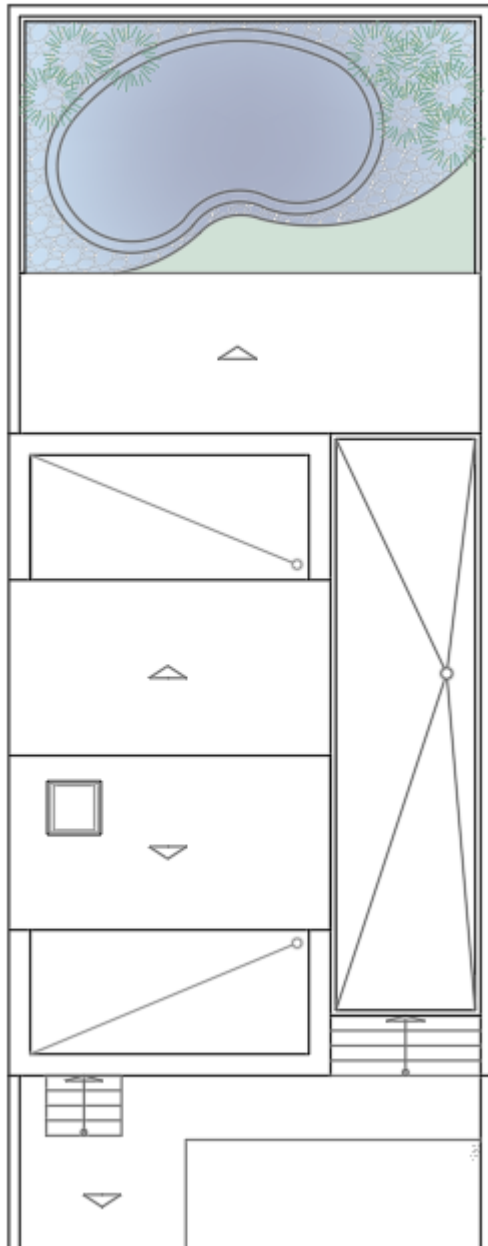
Plano de cubiertas. 2019. Fuente propia.
